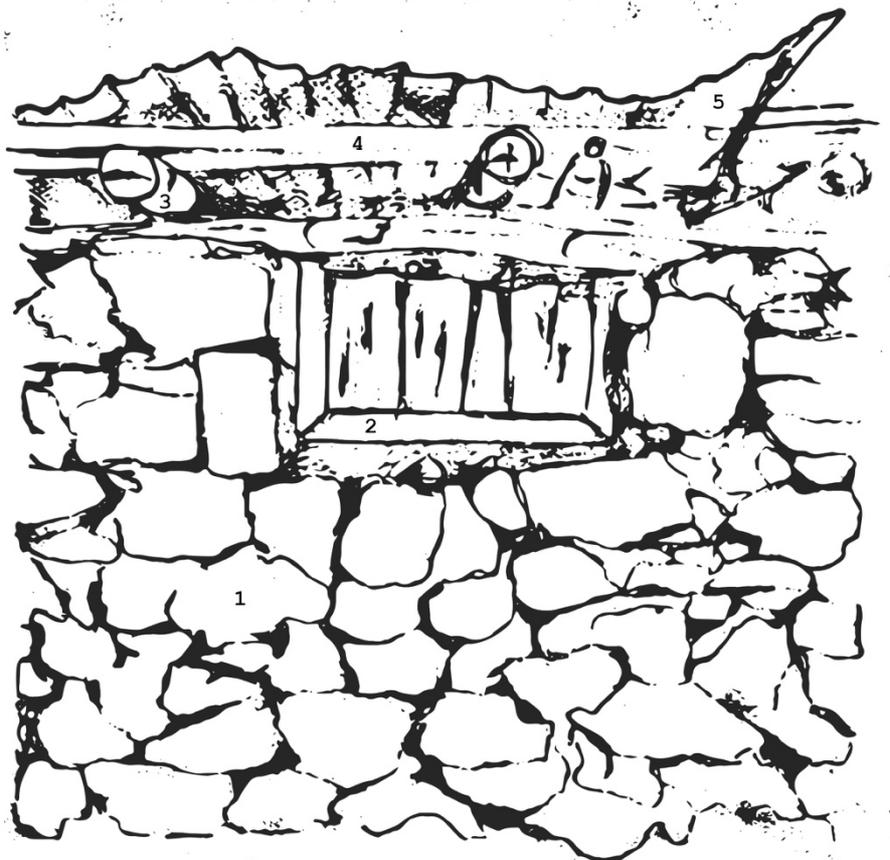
j: Eigene Detailzeichnung der Pferchkonstruktion vor Ort. 1. Mauerwerk 2. Holzfenster 3. Querbalken 4. Dachunterstützung 5. Blechdach
